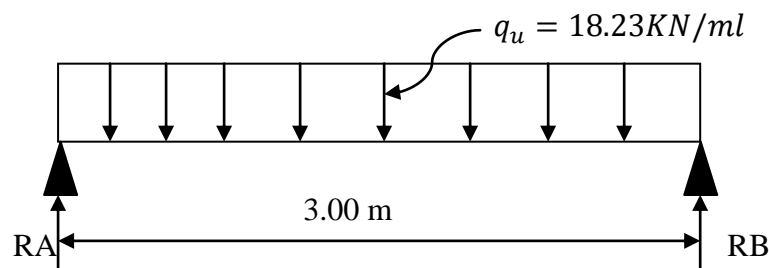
Schéma statique d'une poutre palière à l'ELU.
